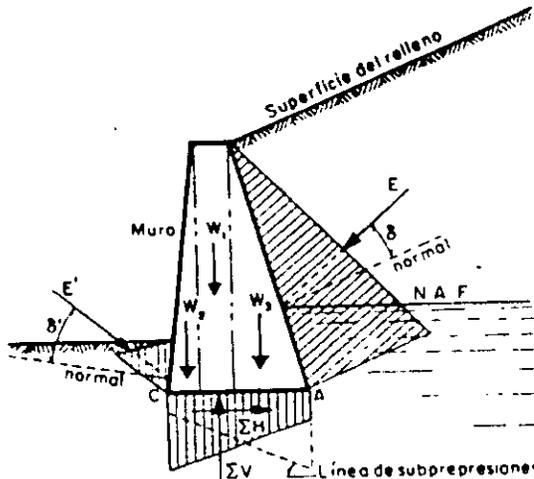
Esquema que muestra las fuerzas principales que actúan sobre un muro de contención
